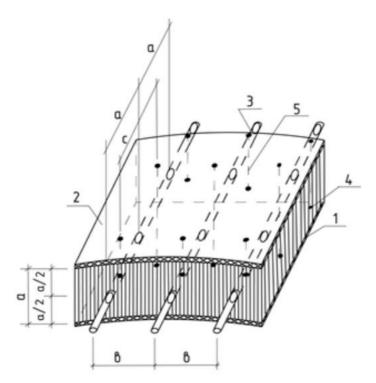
Схема расположения отверстий в трубках и креплений оболочек между собой
